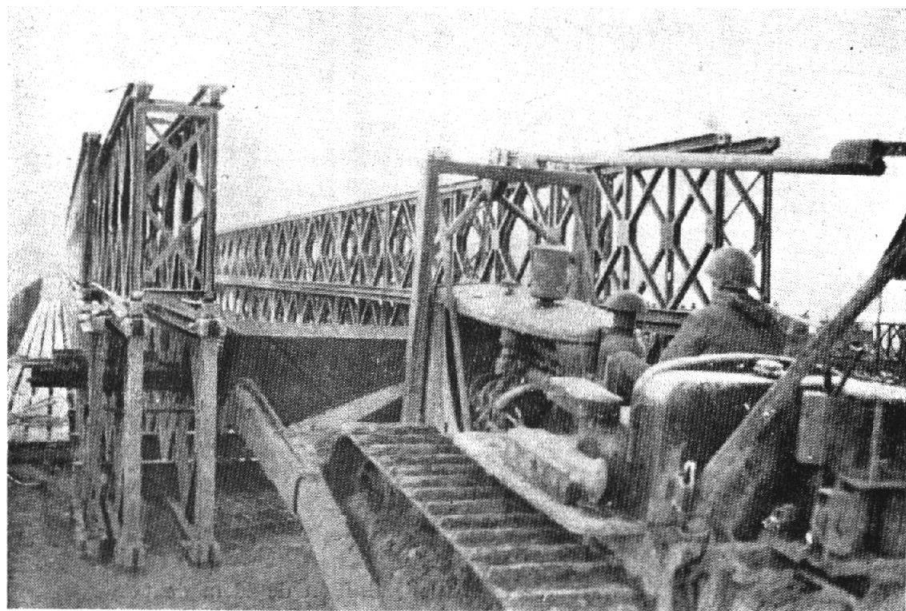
Lancement d'une travée de pont Bailey sur le canal Albert, le 29 décembre 1944, au moyen d'un bulldozer.
